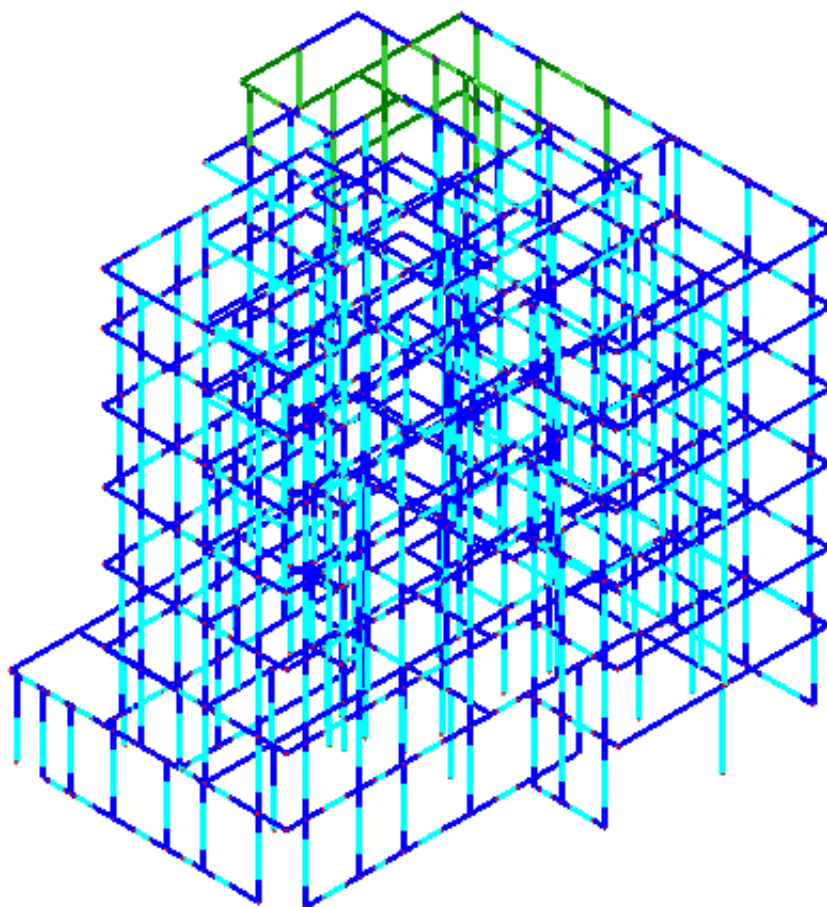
Vista tridimensionale del modello a Telai Equivalenti
